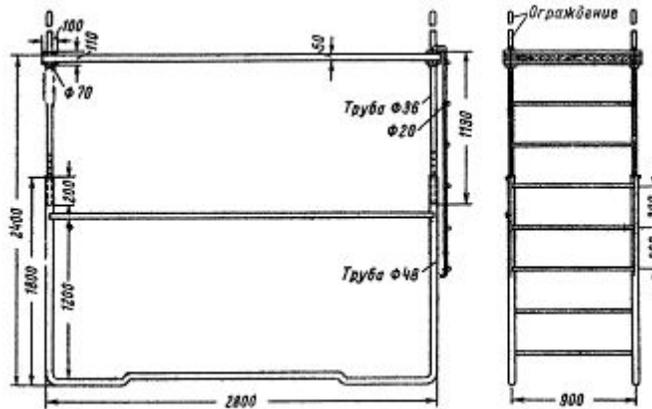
Инвентарный трубчатый столик для монтажа перекрытий
